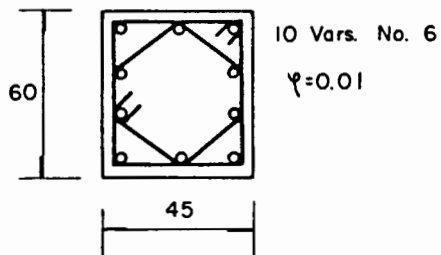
Armado de columnas usando RCDF-87 y Q=4
